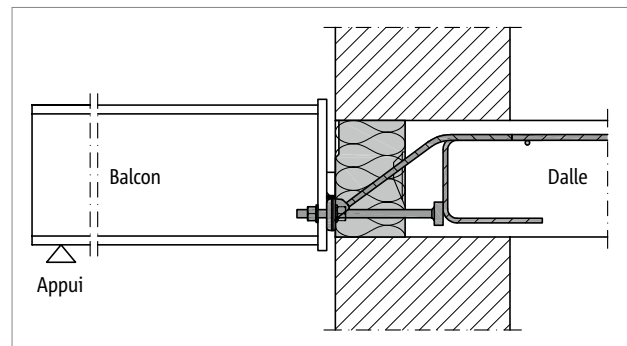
Schöck Isokorb® XT type SQ : raccordement à la dalle en béton armé ; mur avec isolation répartie
